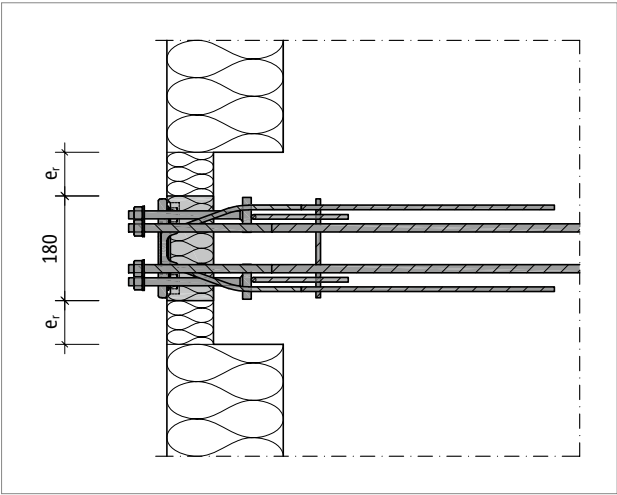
Schöck Isokorb® T type SK : distances aux bords
